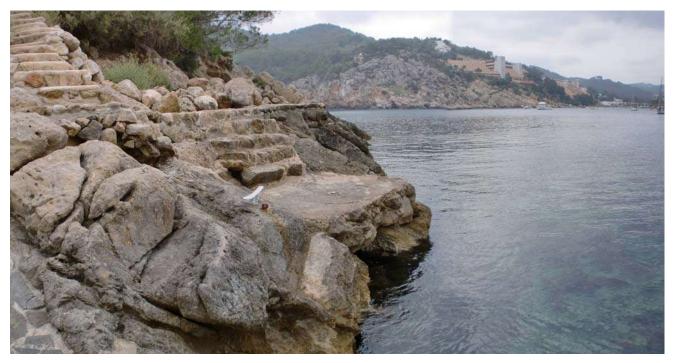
El pequeño embarcadero es una estructura de hormigón sobre una base de roca natural y escollera artificial, en muy mal estado de conservación. Además se encuentra descalzado bajo la estructura de hormigón.
